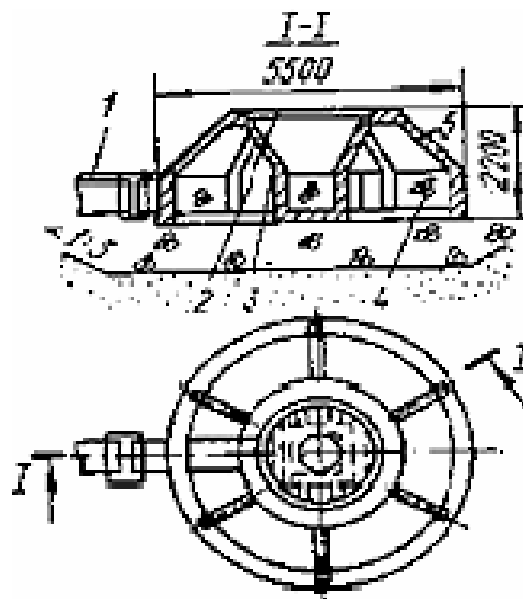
Круглый монолитный железобетонный оголовок:
